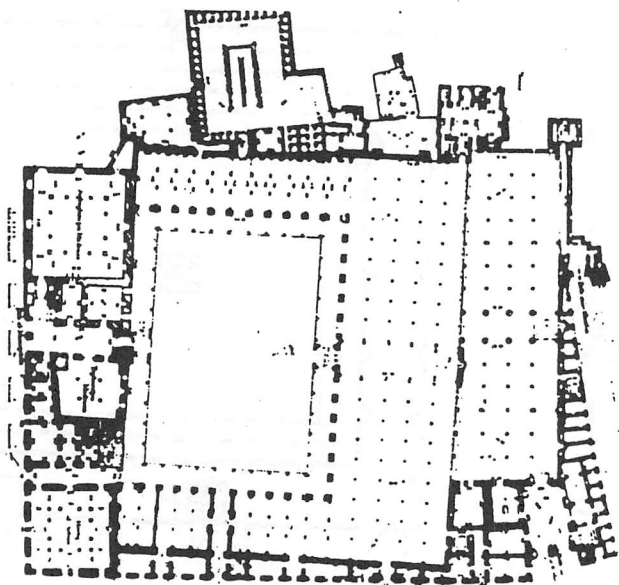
المسقط الأفقي لجامع سامراء الكبير .
